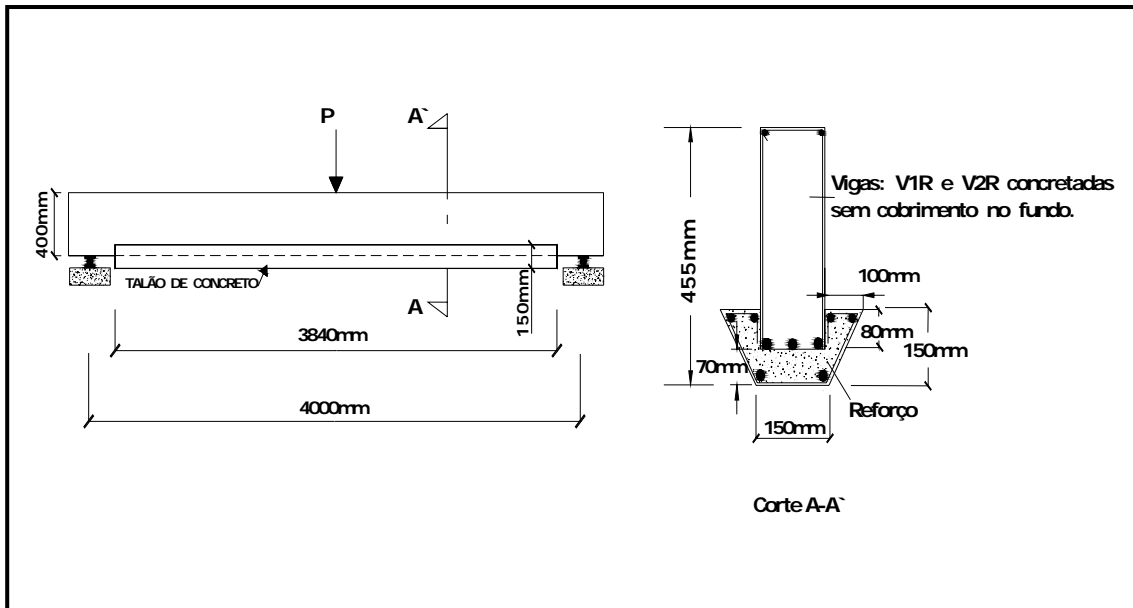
Dimensões e carregamento das vigas V1R e V2R (com reforço).
